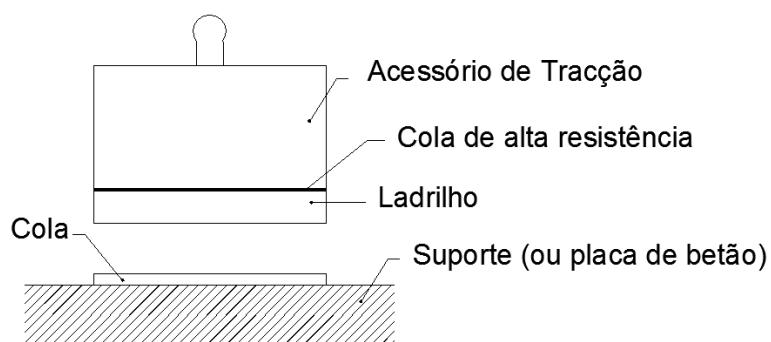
Rotura adesiva entre o ladrilho e a cola (AF-T) [N2]
